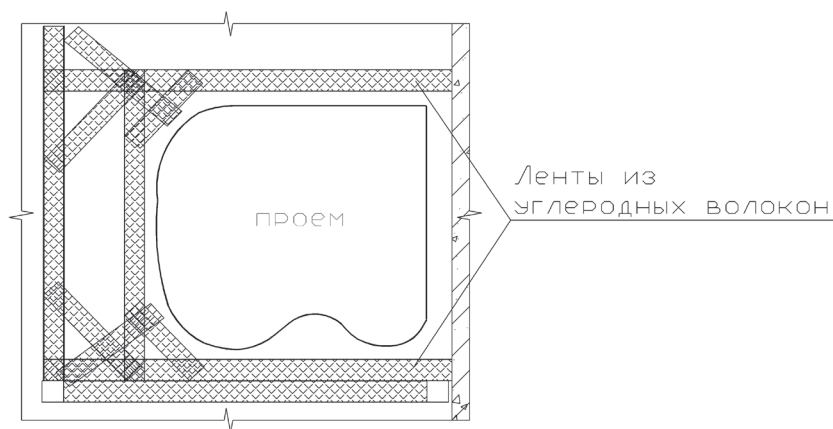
Усиление плиты межэтажного перекрытия с проемом
